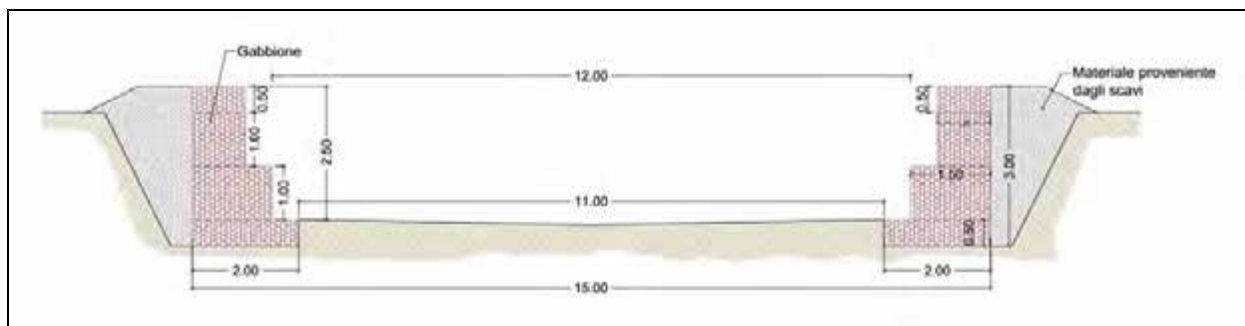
Sezione tipo (da sez. 5.29 a sez. 5.02)
